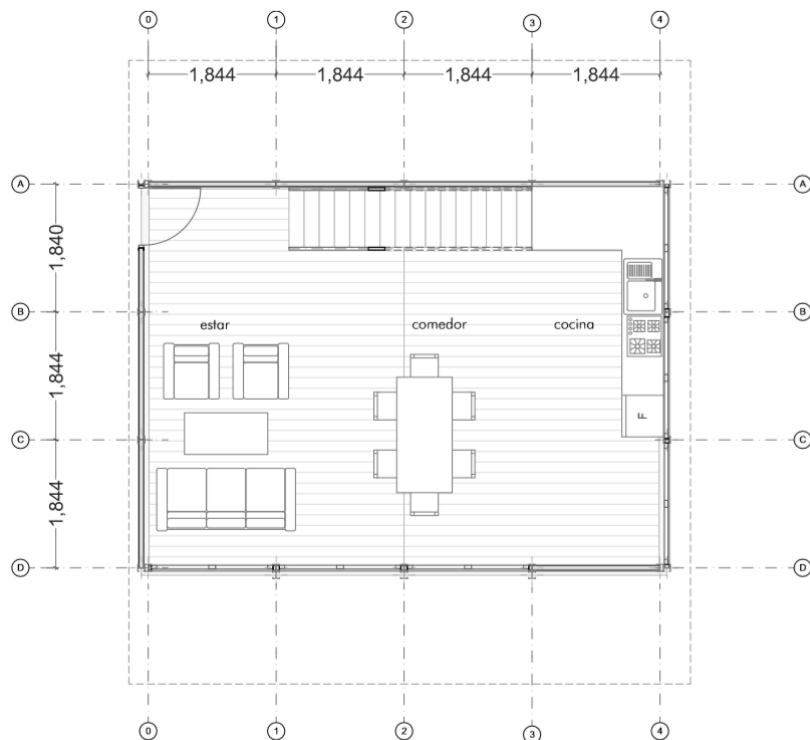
Plano arquitectónico de la planta baja de la vivienda de 2 plantas (Opción B)
